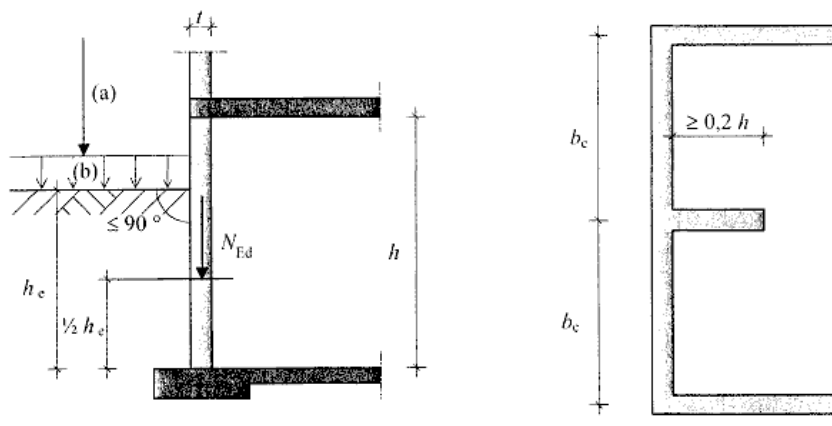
Параметри для розрахунків цокольних стін (поперечний перерізі і фрагменті плану):
